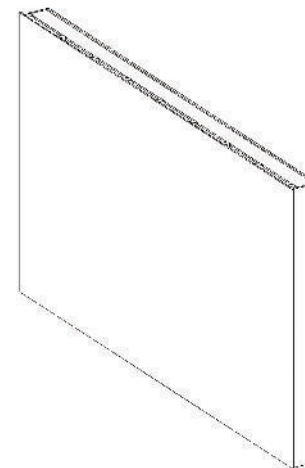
\_ Assonometria della parete assemblata in fabbrica
